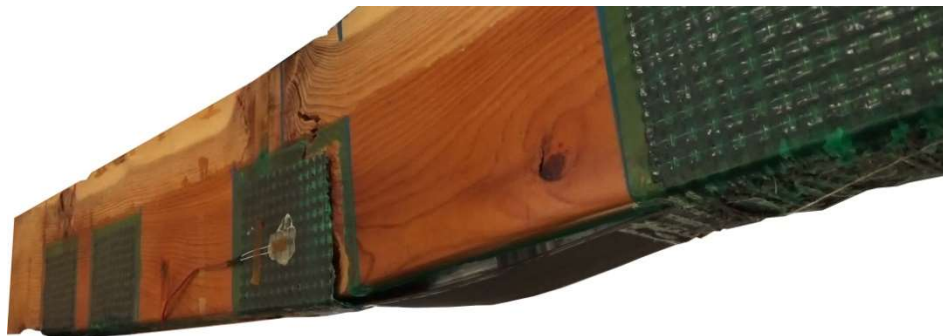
Fotografía de la rotura por tracción de la viga BR-B-1.
